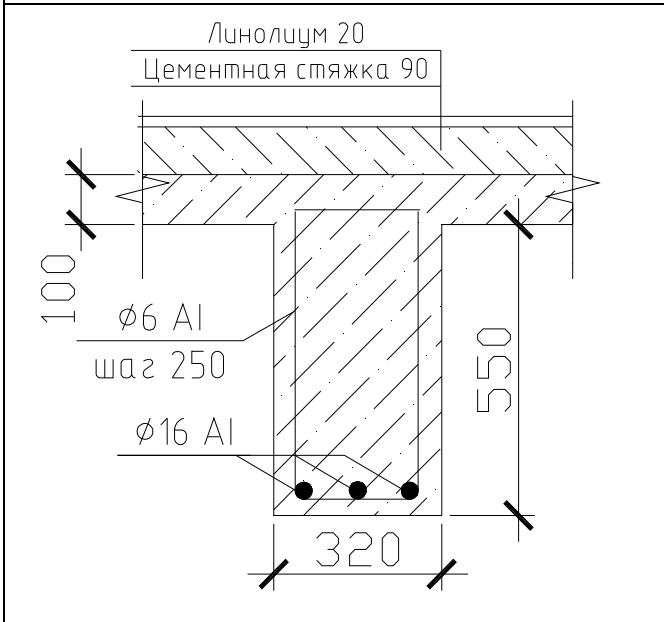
Главная балка ж/б перекрытия над четвертым этажом в осях «8-9/ Б-В»
